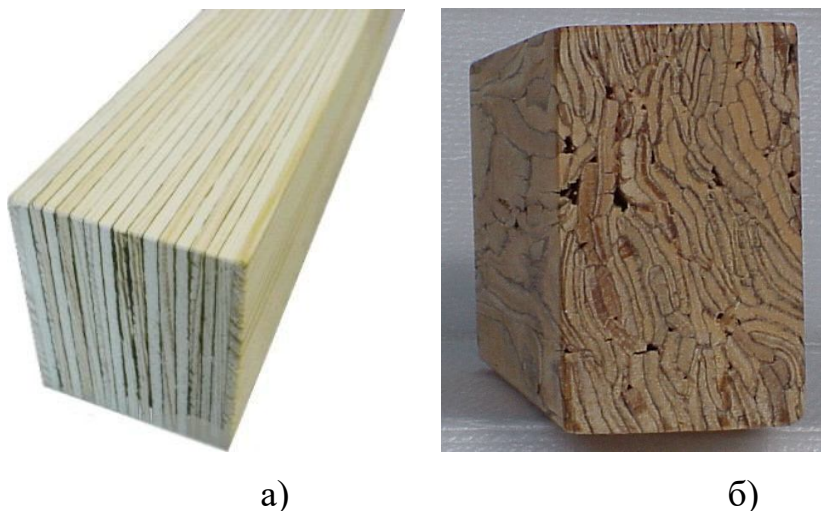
Зовнішній вигляд шпонкового бруса ЛВЛ і конструкційного бруса: а) шпоновий брус ЛВЛ; б) конструкційний брус.
